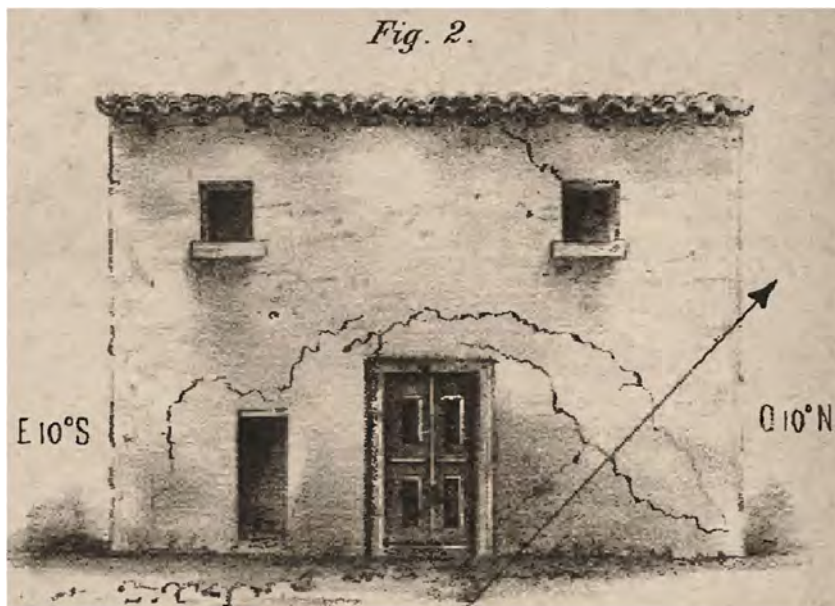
Fachada de una casa privada en Arenas del Rey, dirección E. 10° S.
